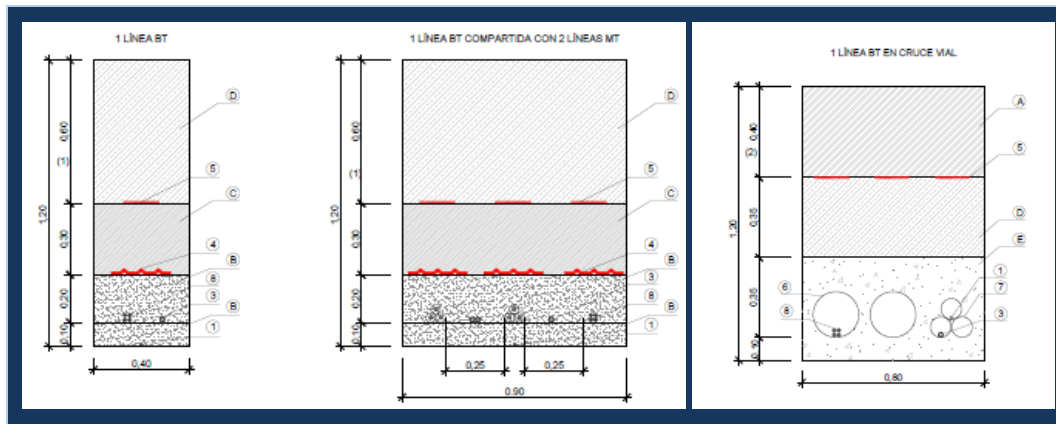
Detalle Sección Zanja. Suministro en BT a torre meteorológica (Lateral vial o tierras y cruce vial)
